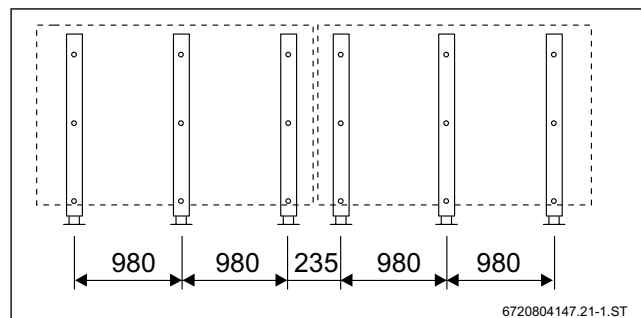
Промежутки (расстояния) между опорами при повышенных нагрузках для монтажа двух горизонтальных гелиоколлекторов SKT1.0-w, угол установки 30° (с анкерным креплением) (Размеры указаны в мм)
